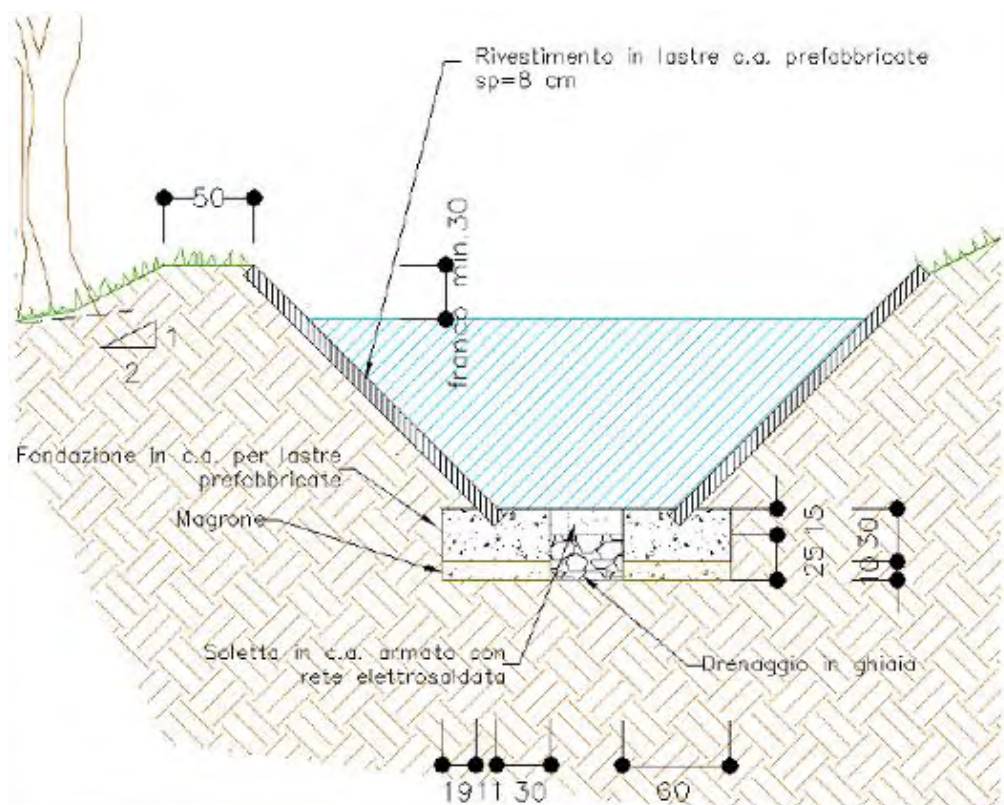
Sezione tipologica del rivestimento del canale con lastre prefabbricate.
